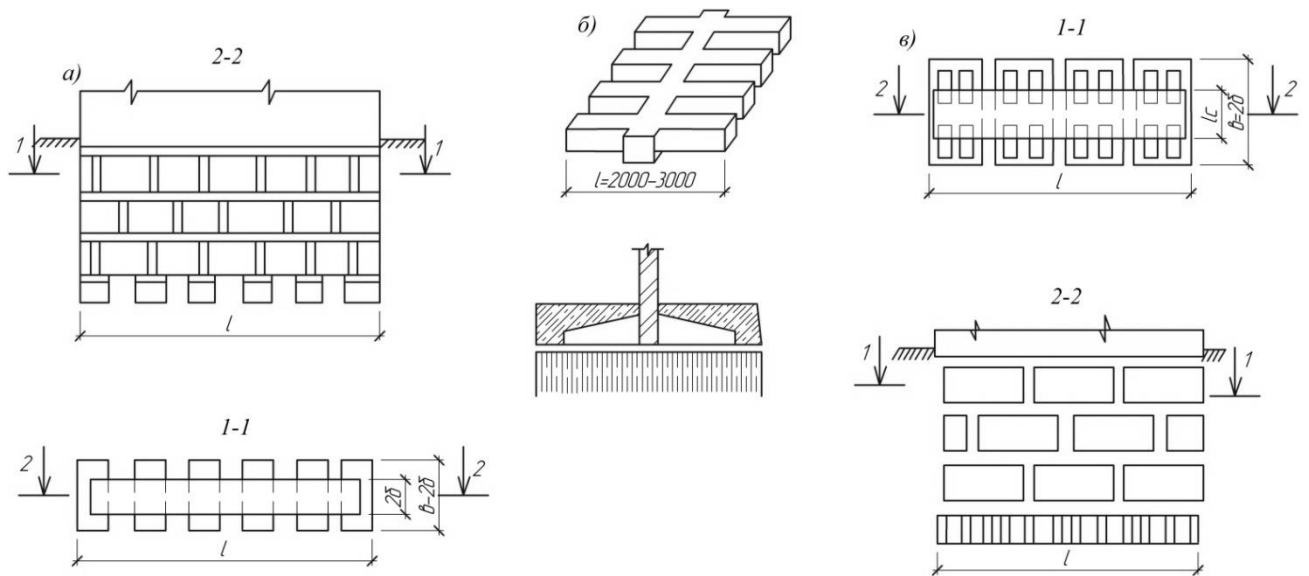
Деякі види переривчастих фундаментів: а - стрічковий переривчастий фундамент; б – переривчасто-шпальний фундамент; в – переривчасто-решітчастий фундамент.
